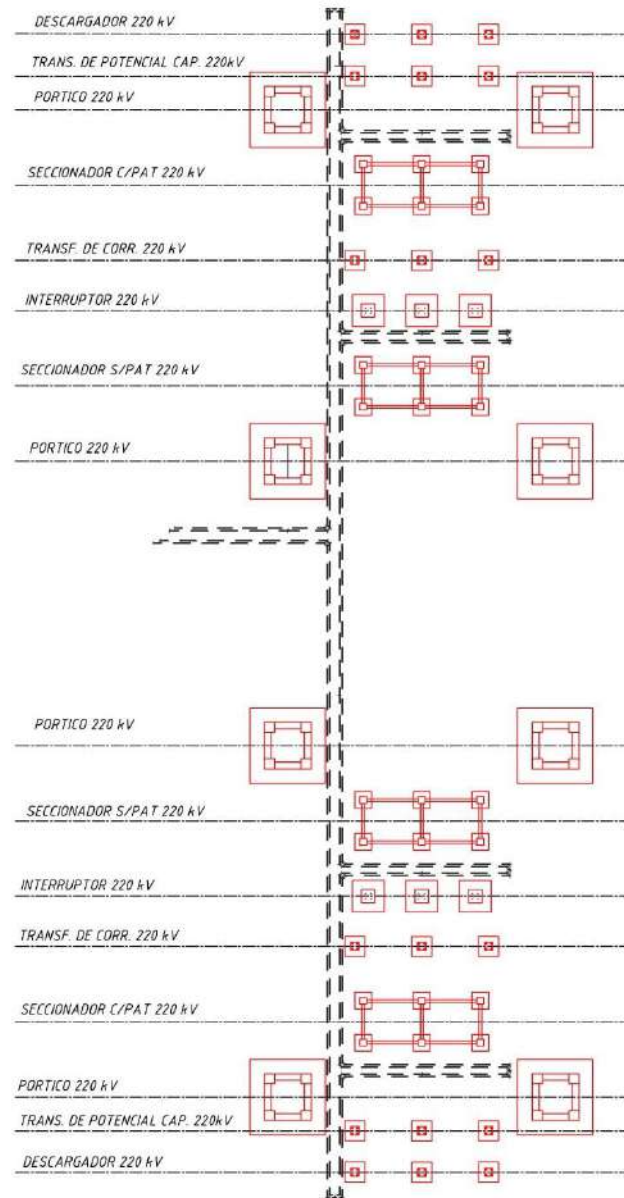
26: Disposición general de las fundaciones de nueva configuración.
